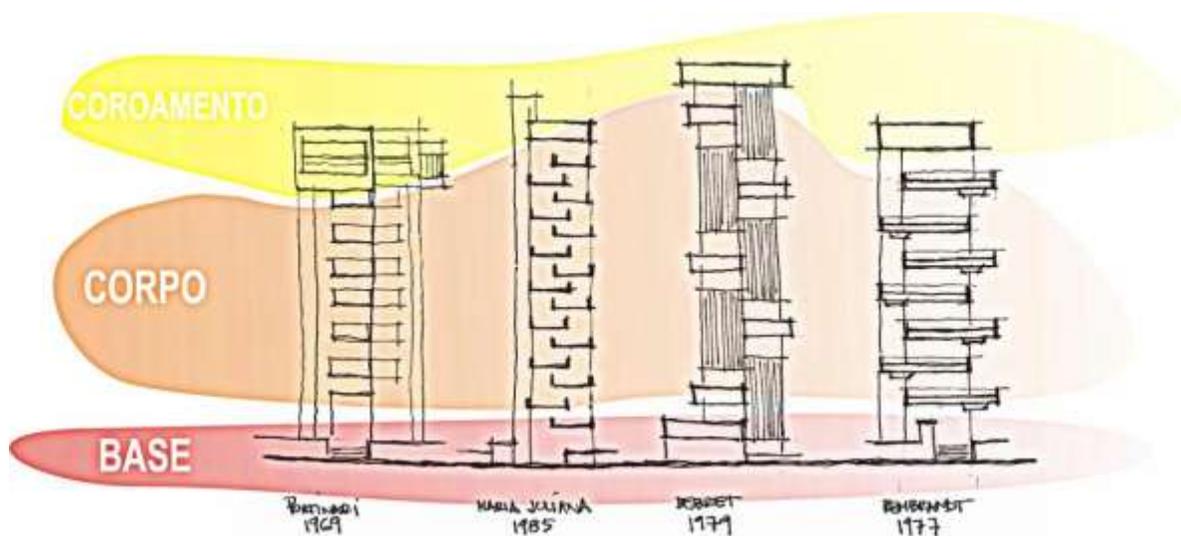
Croqui esquemático de algumas fachadas de edificações verticais de Borsoi. Demonstração da ideia de base, corpo e coroamento. Croqui: CANTALICE II.
